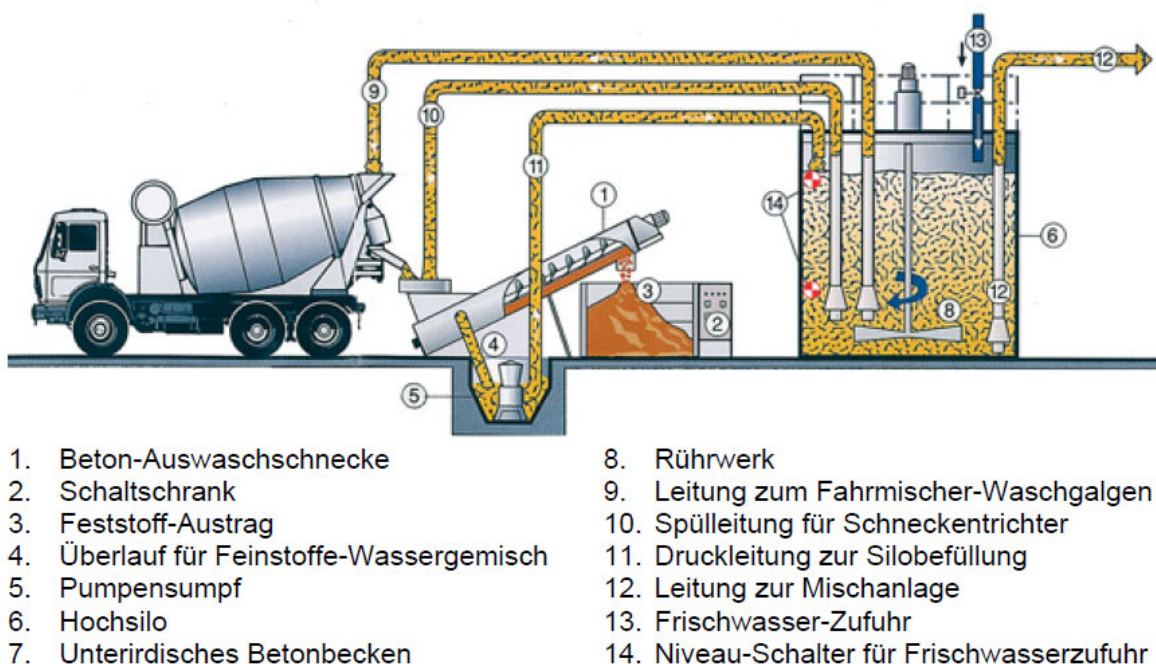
Funktionsschema einer Frischbetonrecyclinganlage [10]
